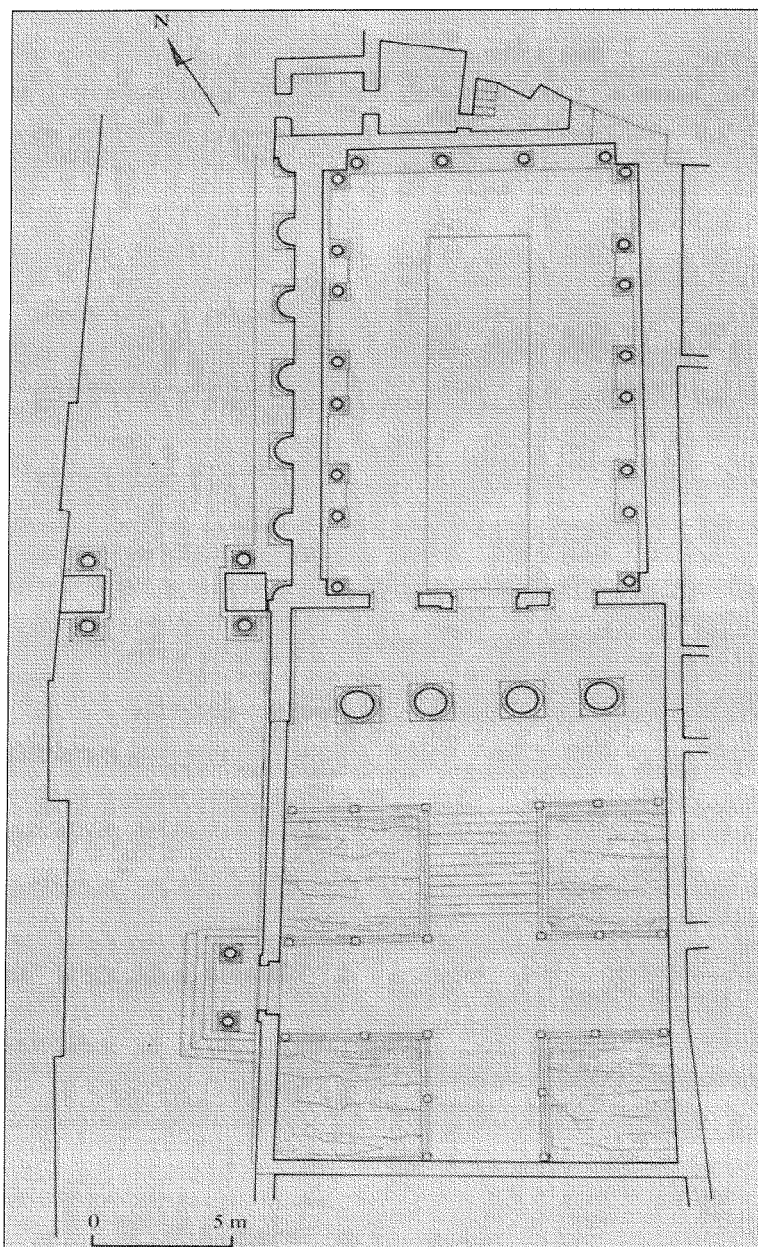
Plan du sanctuaire, restitution de Golvin. La petite porte d'accès à la salle disposée sous le pronaos, située au pied de l'arc, ne figure pas sur ce plan.
